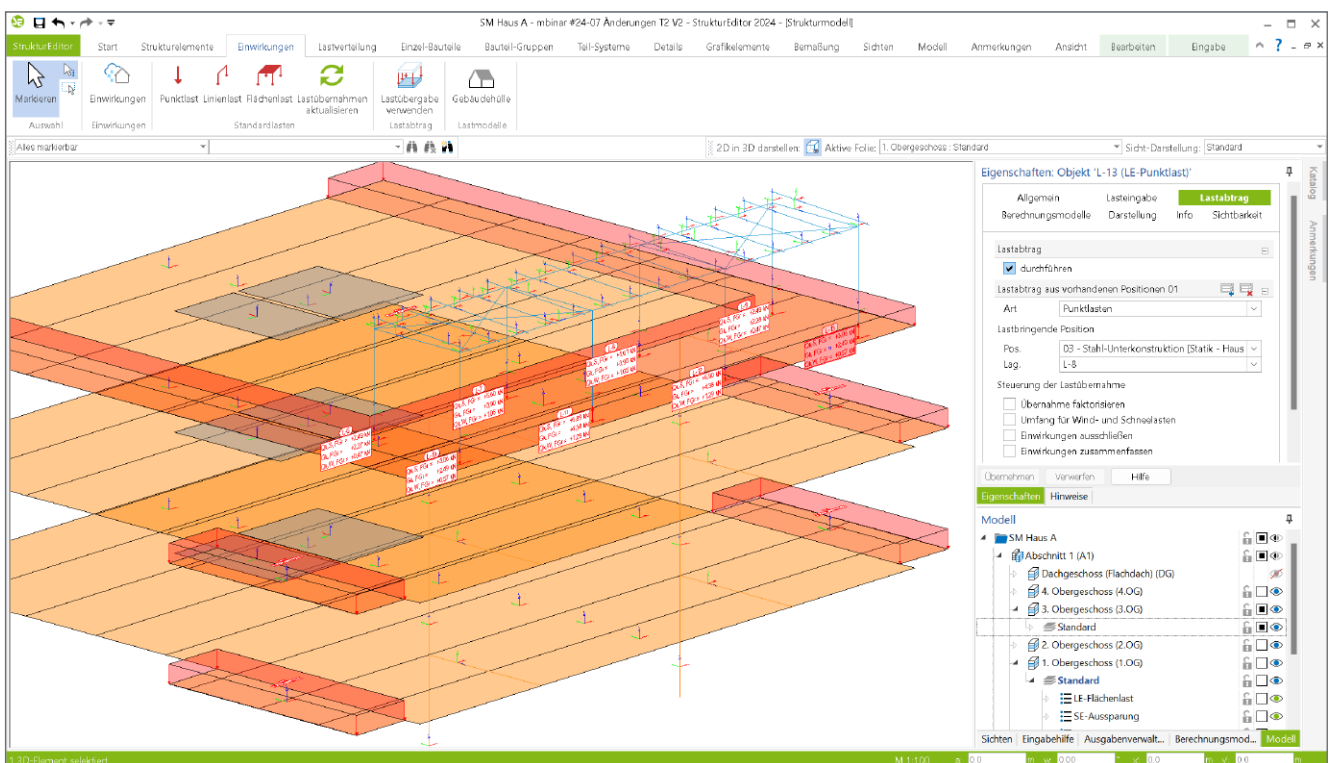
Bauteilbezogene Lasten und Last-Elemente für die Geschossdecken
